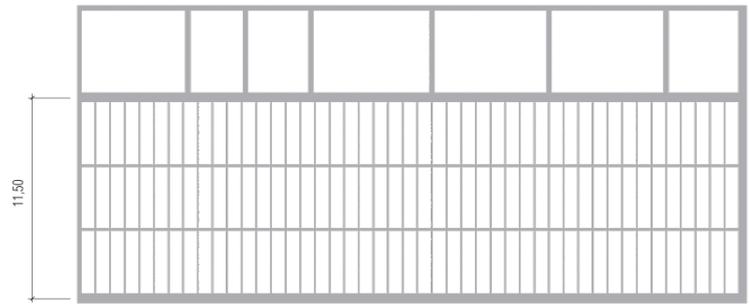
Esquema da Planta de formas do pavimento tipo, Edifício Fiplasto, 1971-1978.
